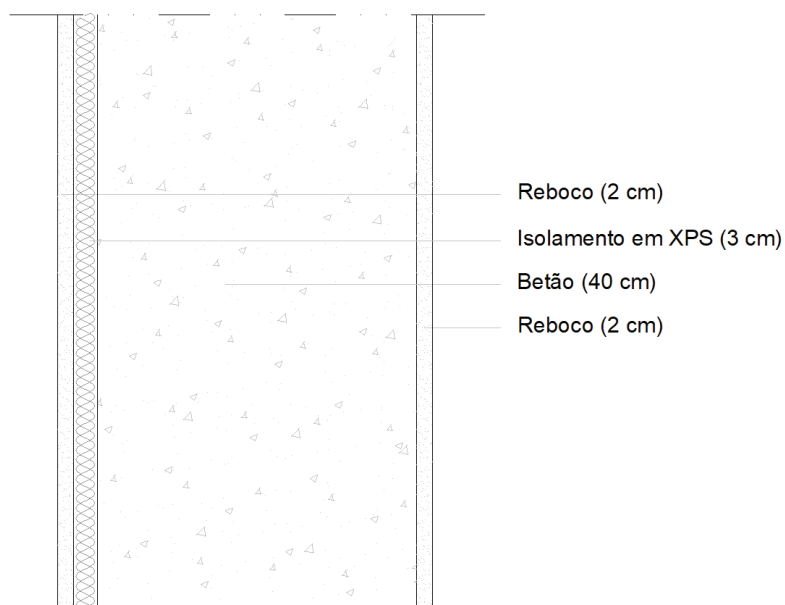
Pormenor construtivo da parede exterior tipo V
